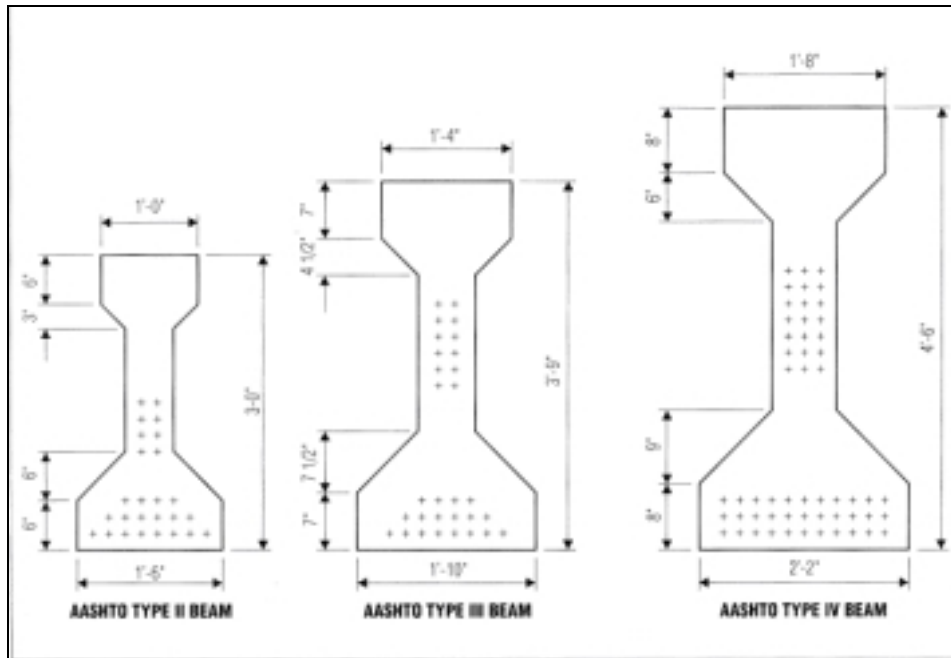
Tres diferentes tipos de vigas I de concreto pre-esforzado, especificadas por AASHTO. La ubicación y número de cables pre-tensados puede variar. (Tomada de Standard Plans for Highway Bridges, vol.I, Concrete Superstructures, FHWA, Ref 3.4.)
